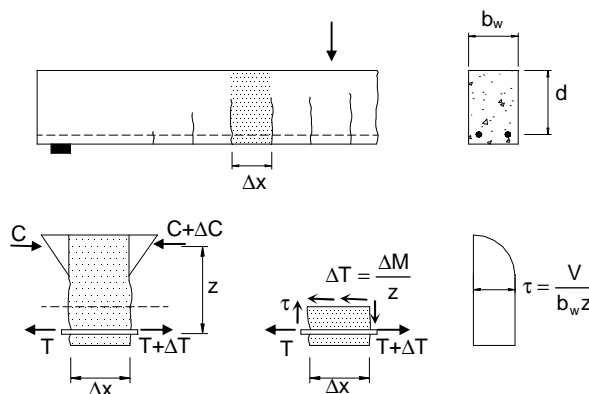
Distribución de las tensiones tangenciales en una viga de hormigón armado con fisuras de flexión (adaptado de Collins y Mitchell, 1991)
